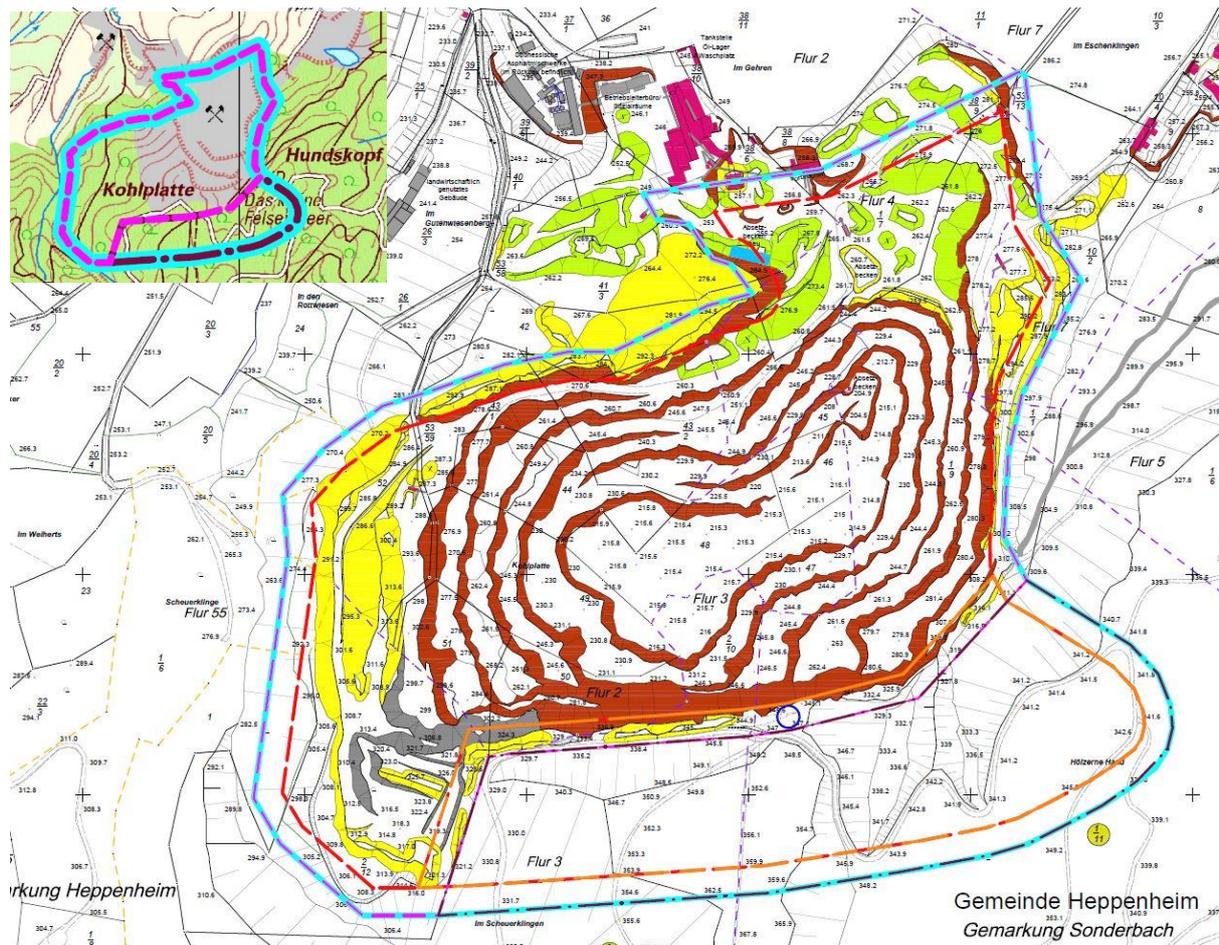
Darstellung der angestrebten Planfeststellungsgrenze (durchgehend breit und hellblau markiert)
